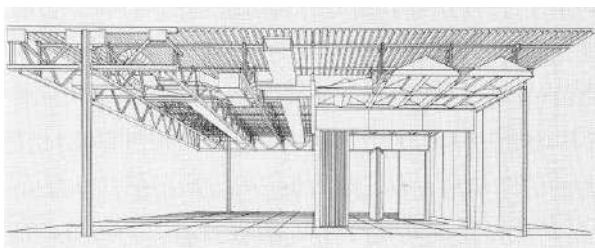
Sistema constructivo *School Construction System Development* (SCDC) (1967). Fuente; Ogata, 2013, p.141.
